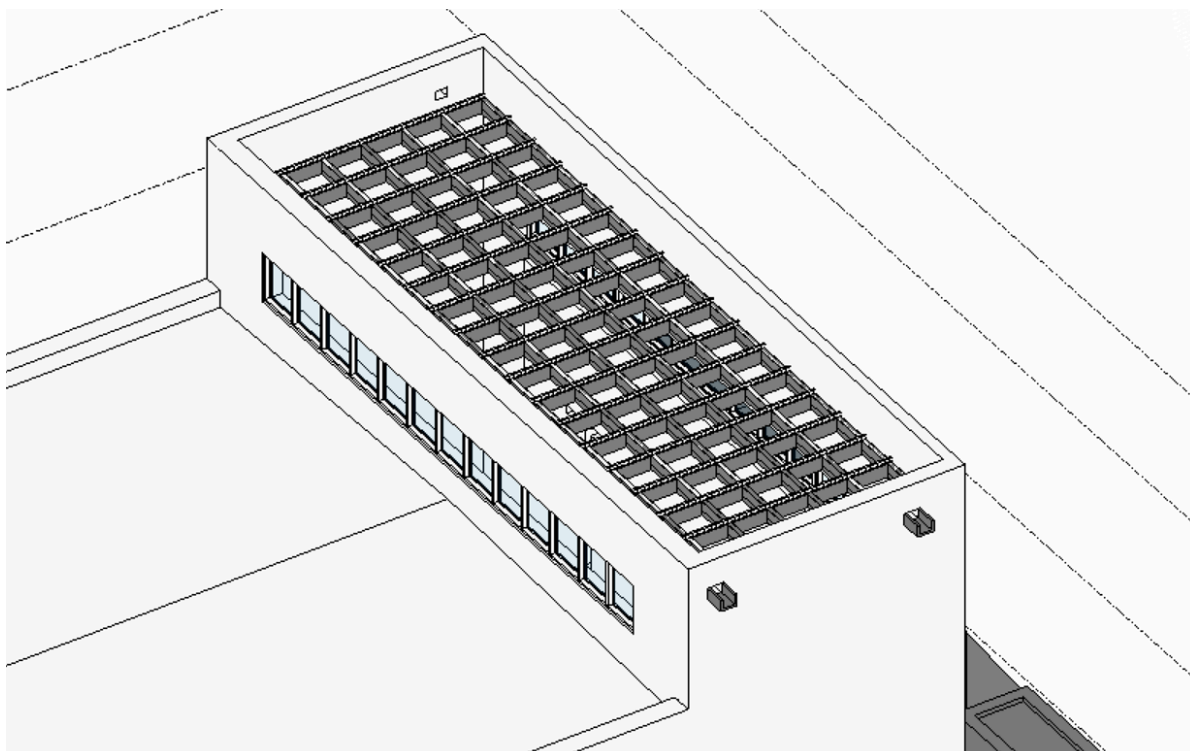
Cubierta arquitectónica de la Zona Altar
